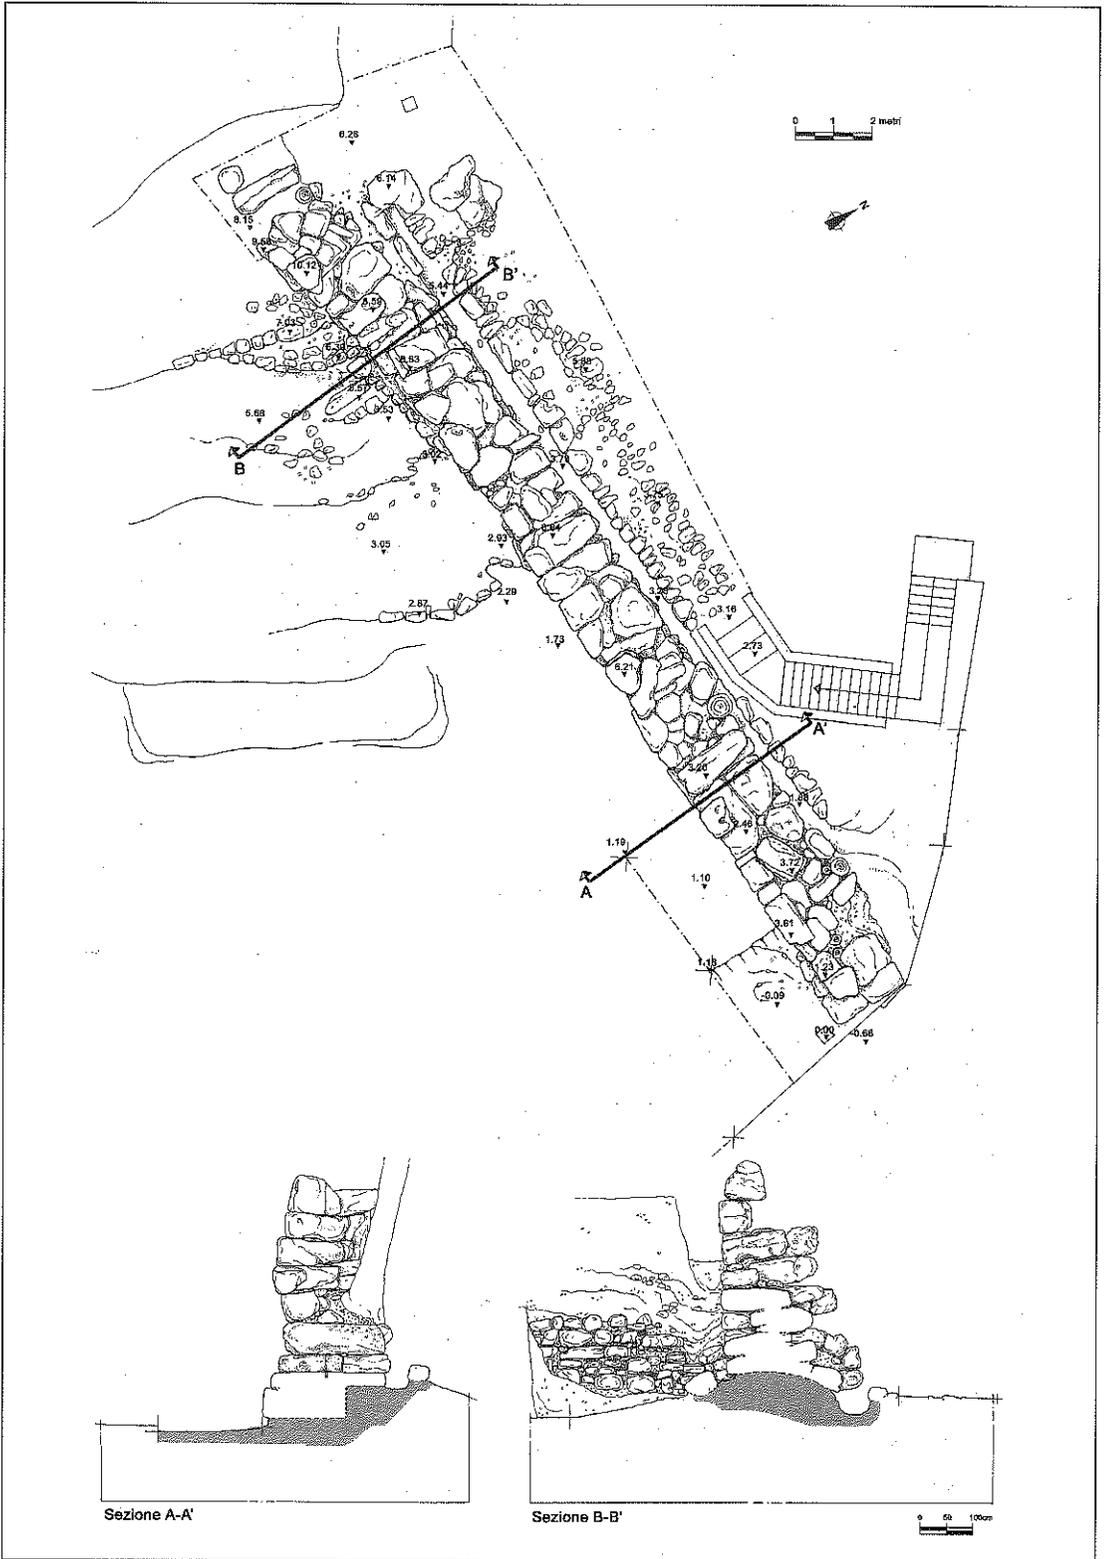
Volterra. Località S. Andrea: muro etrusco, pianta e sezioni.
